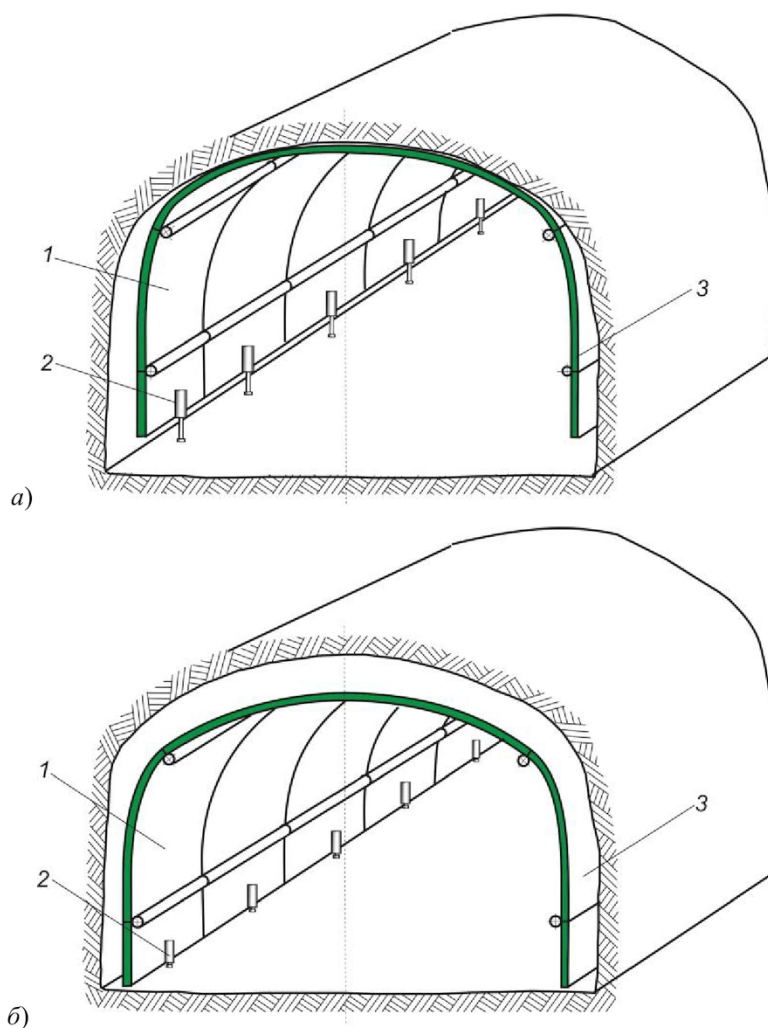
Опалубка для возведения бетонной крепи горизонтальных горных выработок:
